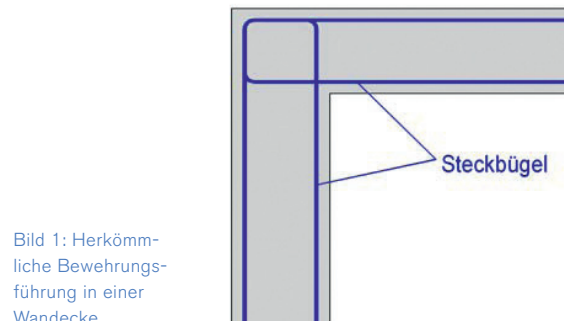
Herkömmliche Bewehrungsführung in einer Wandecke
